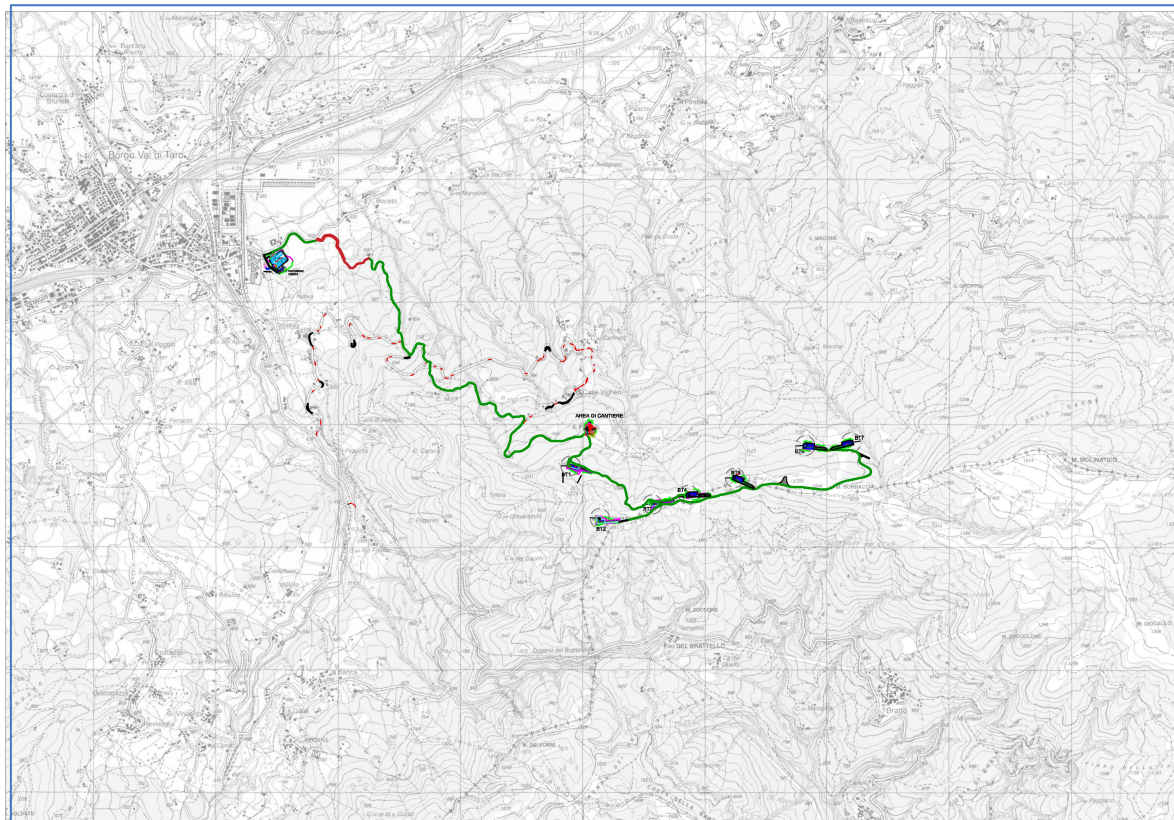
PLANIMETRIA LAYOUT IMPIANTO \_ COROGRAFIA IGM”
